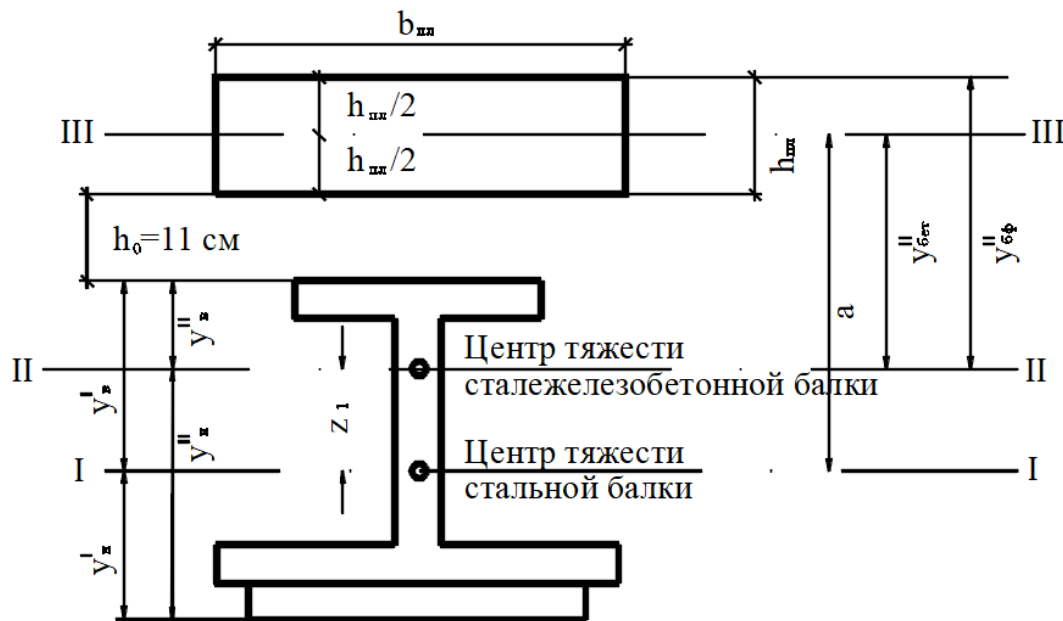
Расчетная схема поперечного сечения крайней главной балки частью железобетонной плиты (2 стадия работы)
